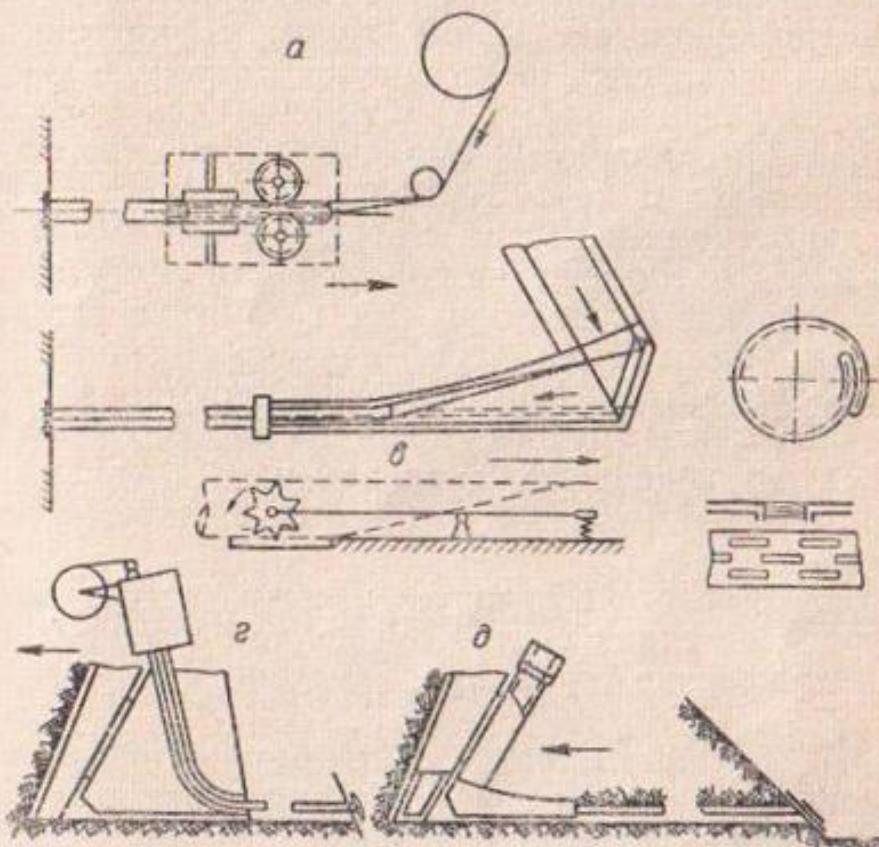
Схемы формирования и укладки пластмассовых дрен из ленты:
